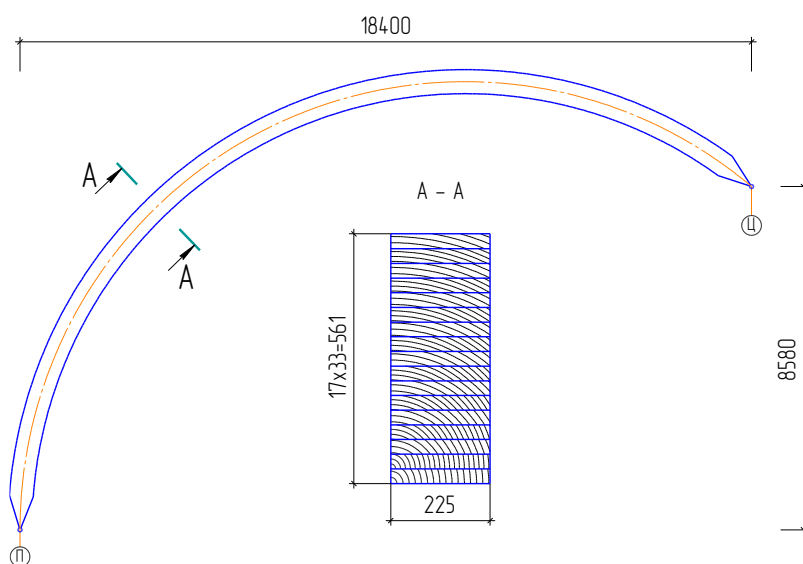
Схема та поперечний розріз дерев'яної арки
